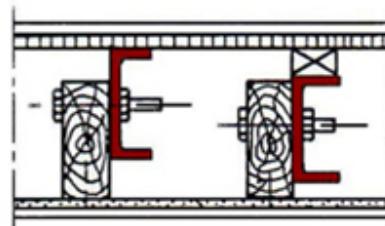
; Imagen 4-26: Colocación en paralelo de perfil metálico. Reparación de apoyos dañados añadiendo placas metálicas con pernos
